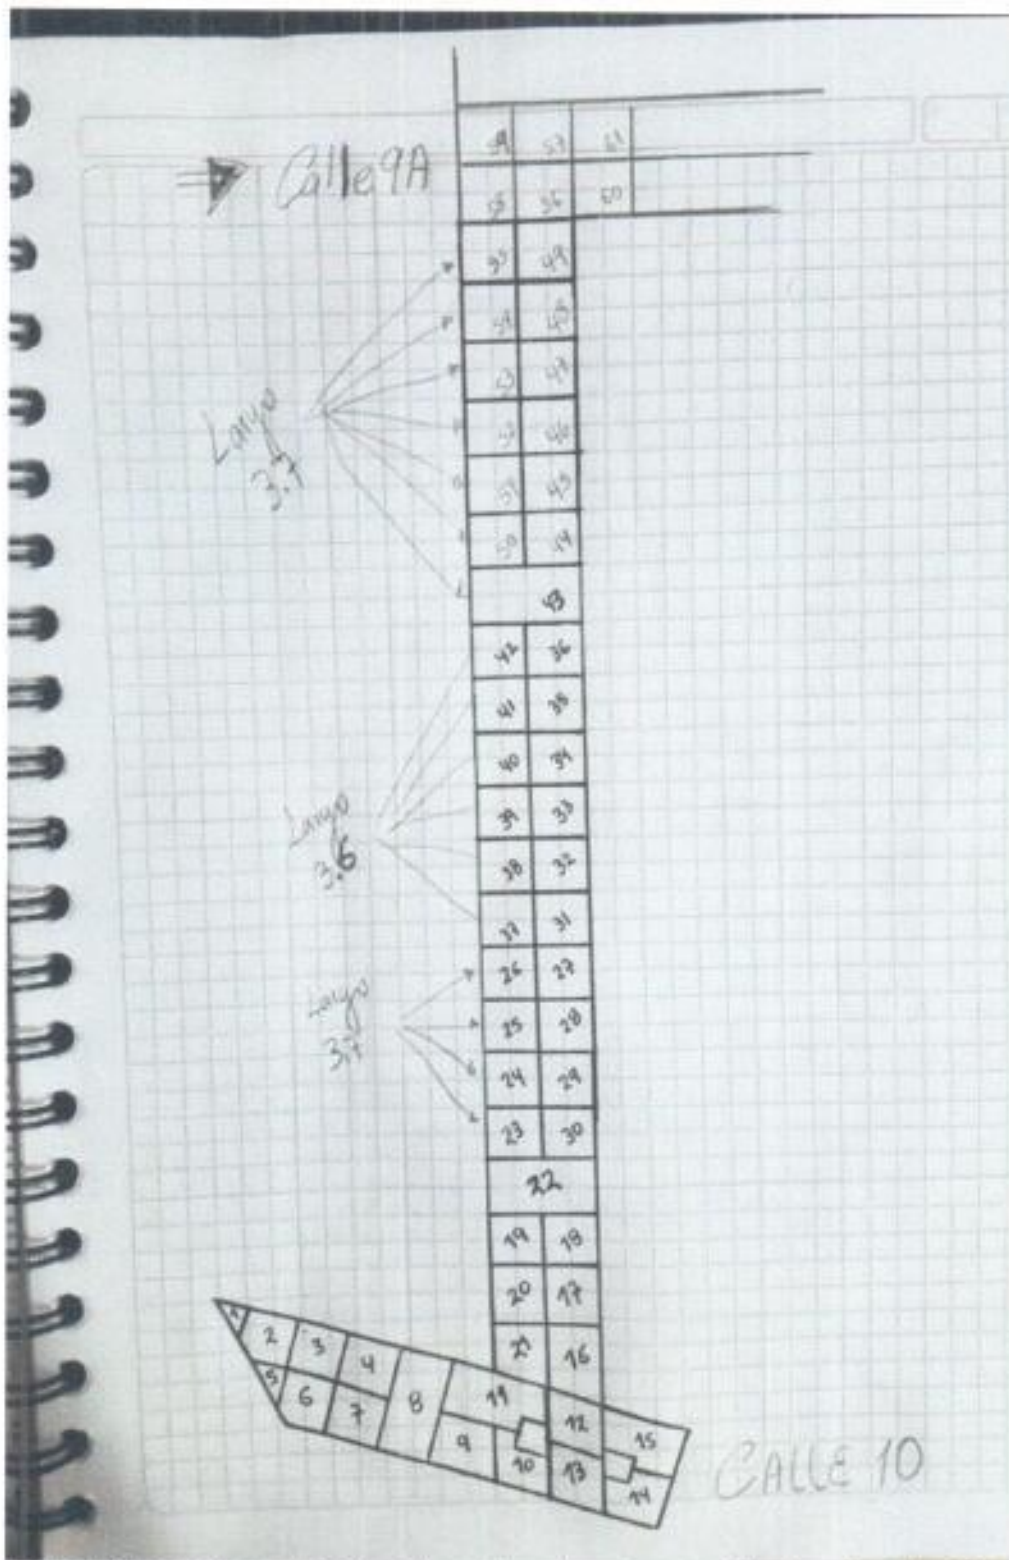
Esquema modulación de losas de pavimento carrera 3 entre calles 10 y 9A.
